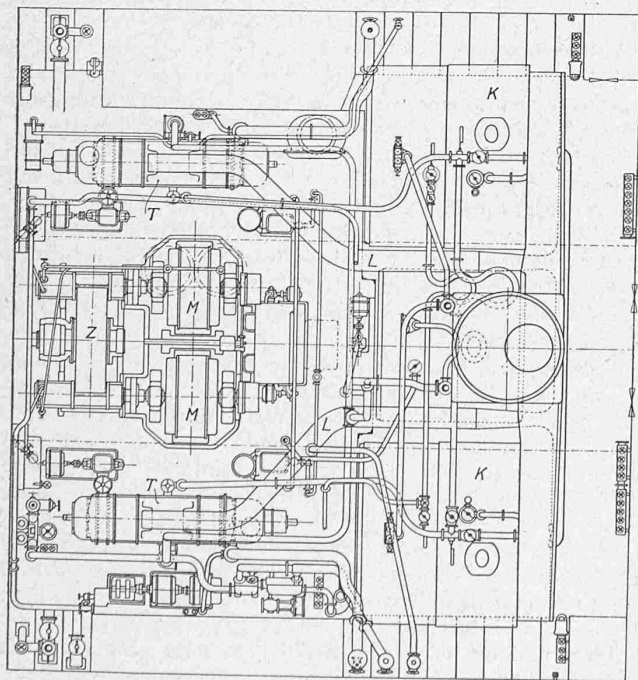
Grundriss des Maschinenraums. — 1:150.
